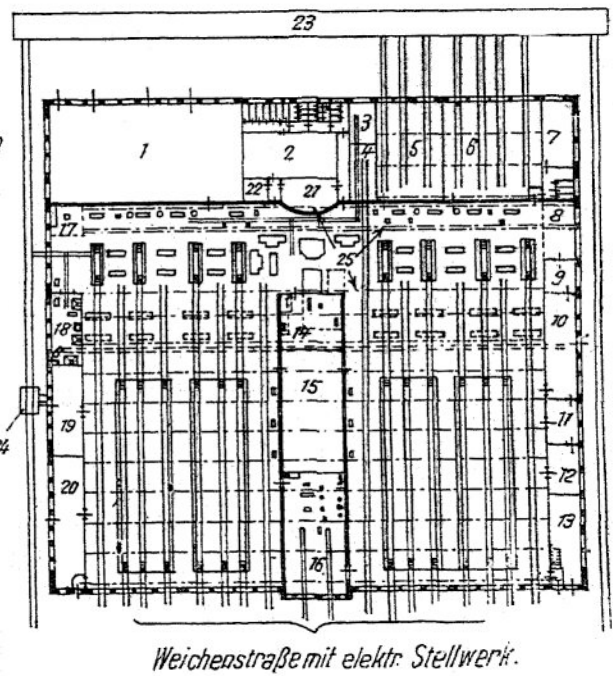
Grundriß einer Straßenbahn-Musterwerkstatt.
